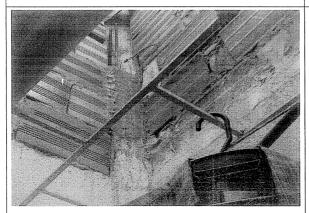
Cara interna del muro del costado norte, columneta fundida hasta la mitad de la altura.
